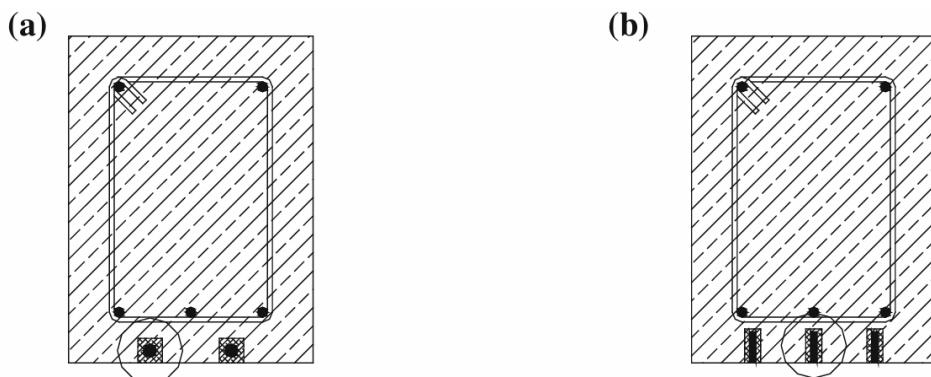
Разрез ж/б балки, усиленной системой *NSM* с применением композитной арматуры круглого и прямоугольного профиля
